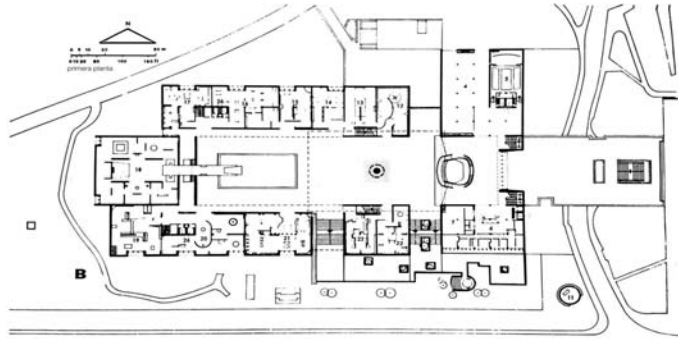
Planta Baja de Museo Nacional de Antropología e Historia, del Arq. Pedro Ramírez Vázquez.
